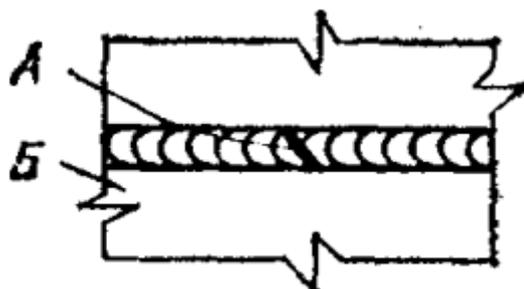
Поперечная трещина А в сварных швах стенки резервуара - сквозная или несквозная
